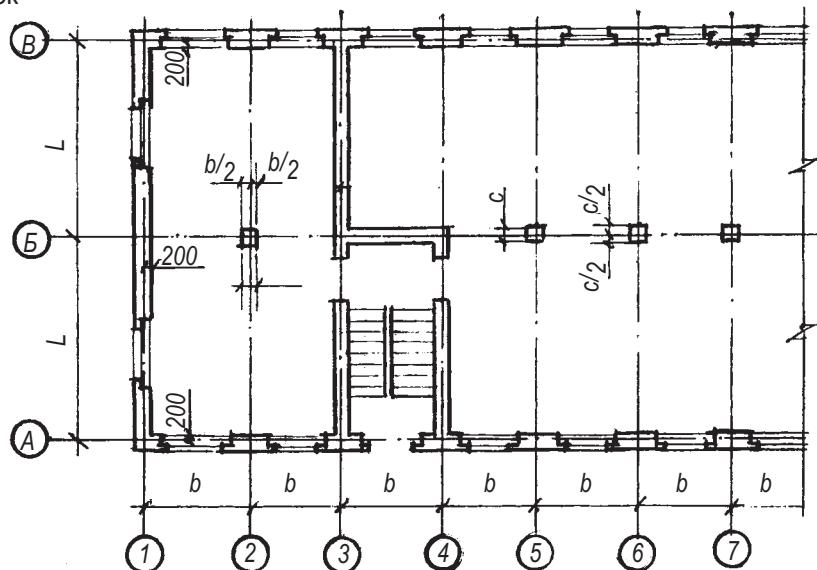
Схема розташування координатичних осей в плані будівлі:
